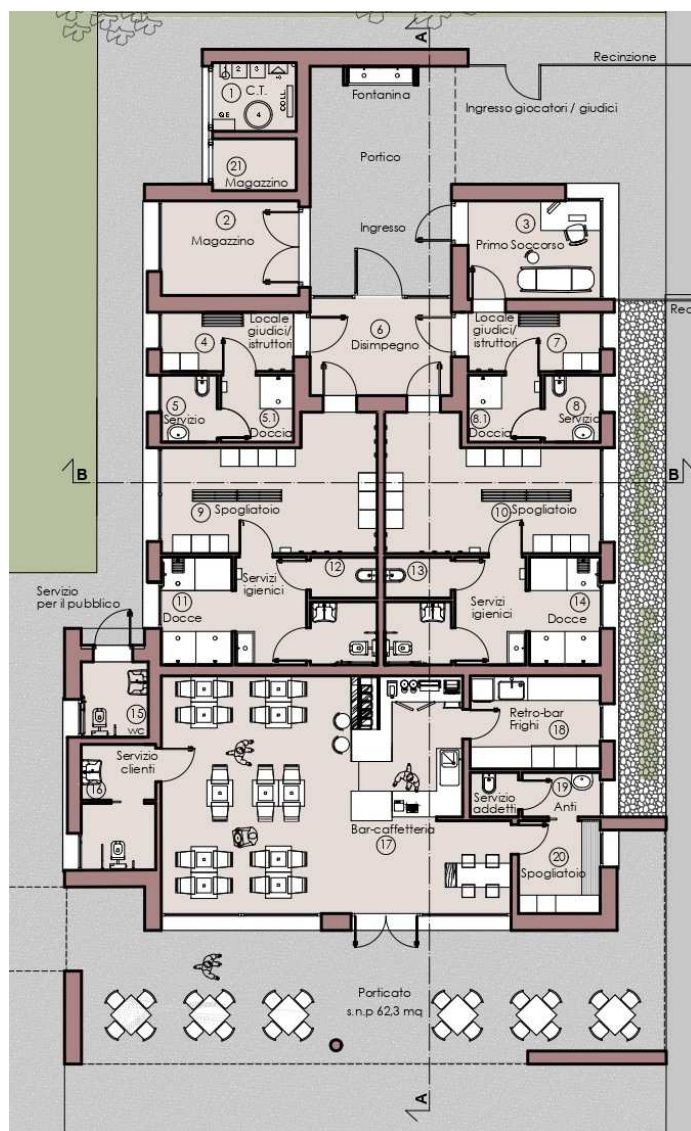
PLANIMETRIA INTERVENTO LOTTO A
